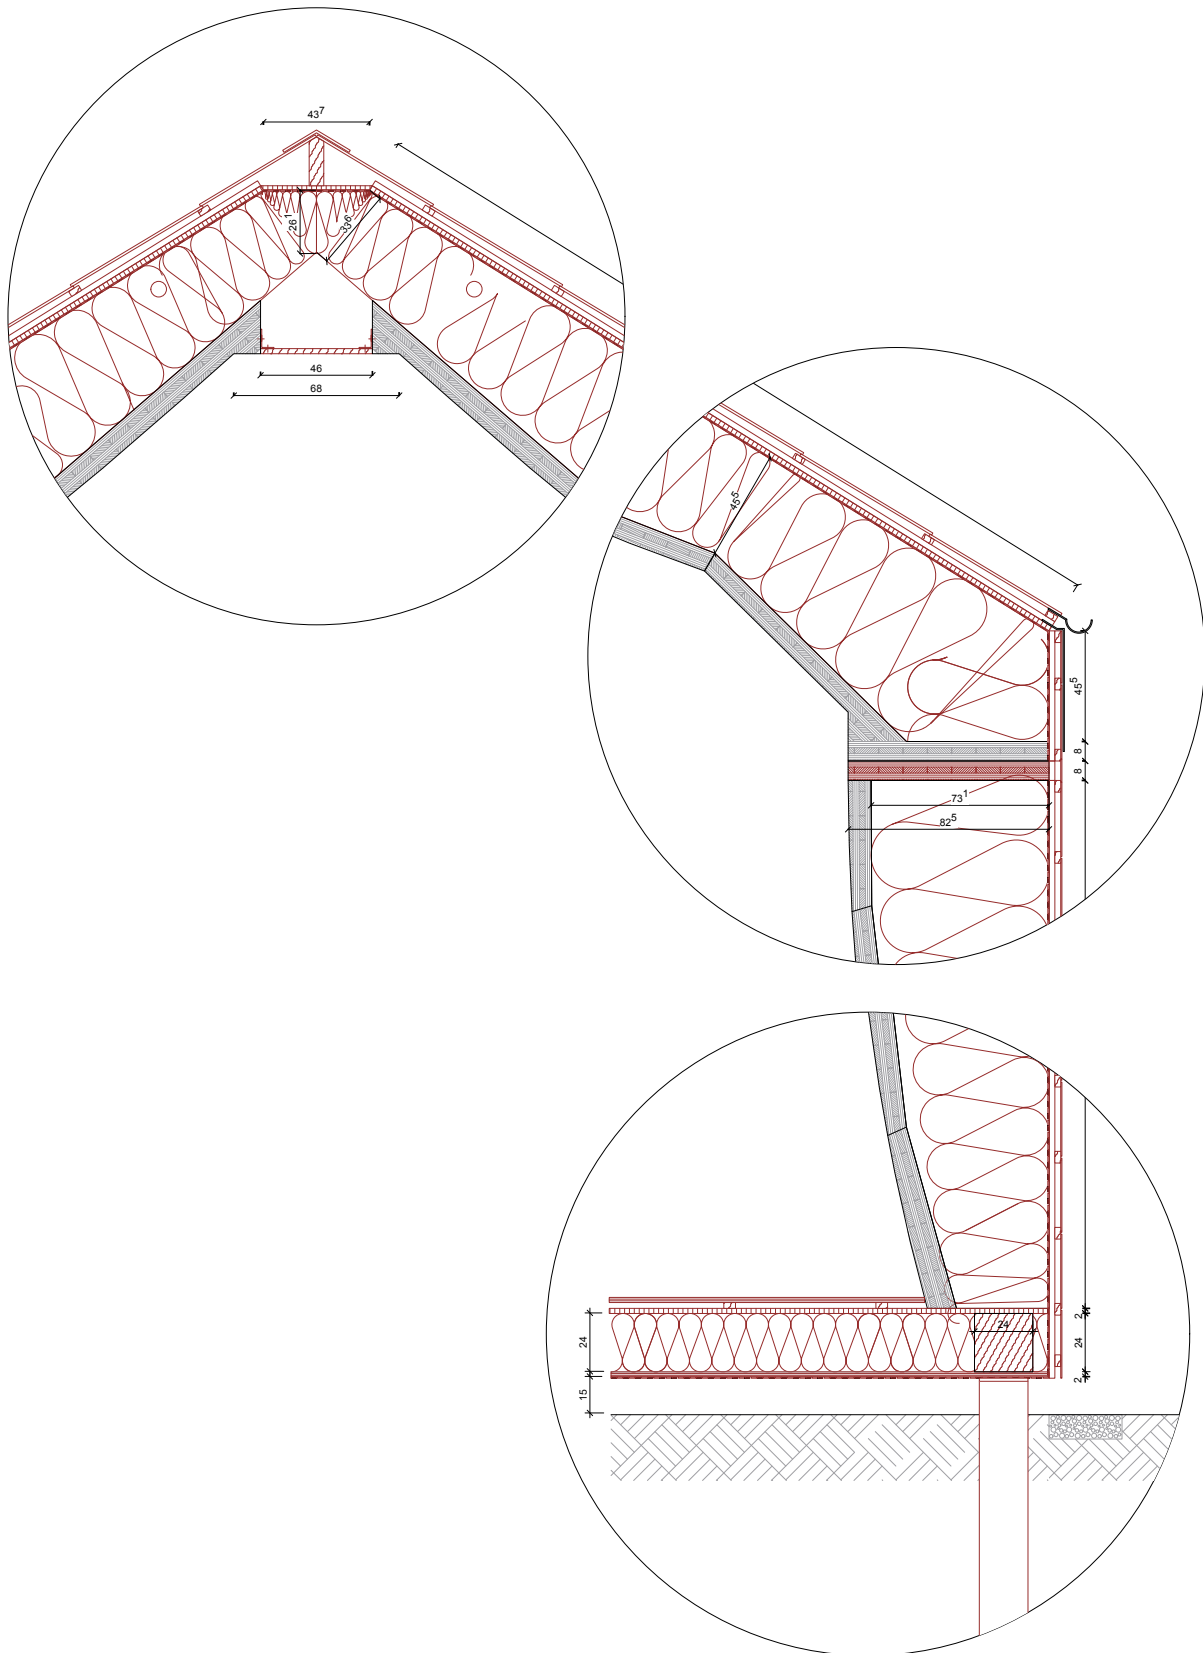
Detailschnitte (schwarz: Schalungselemente, rot: ergänzende Bauteile); links oben: Firstanschluss; rechts oben: Traufanschluss mit Elementstoß; rechts unten: Sockelanschluss mit Fundamentierung
